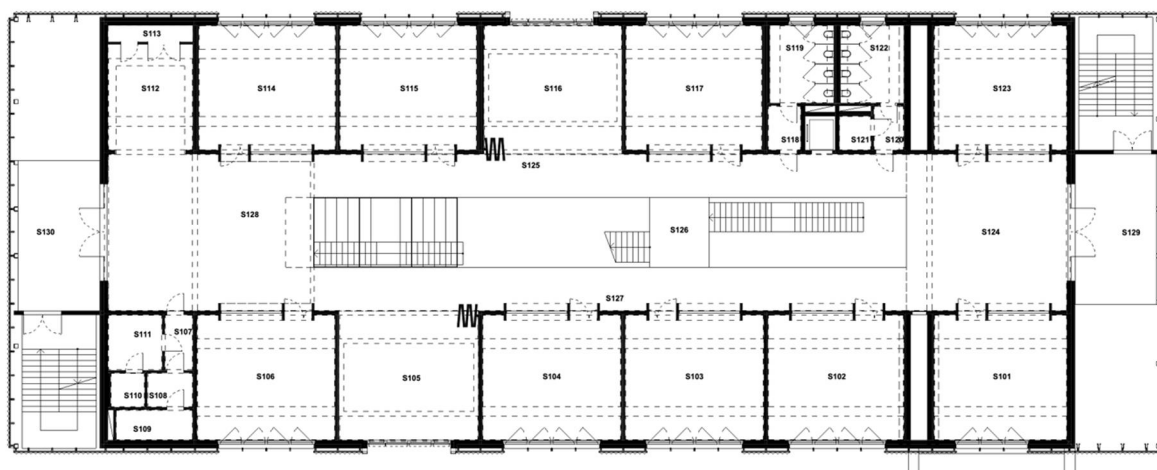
Pianta piano primo con indicazione delle facciate su cui verranno eseguite le verifiche di isolamento standardizzato di facciata_SCUOLA
